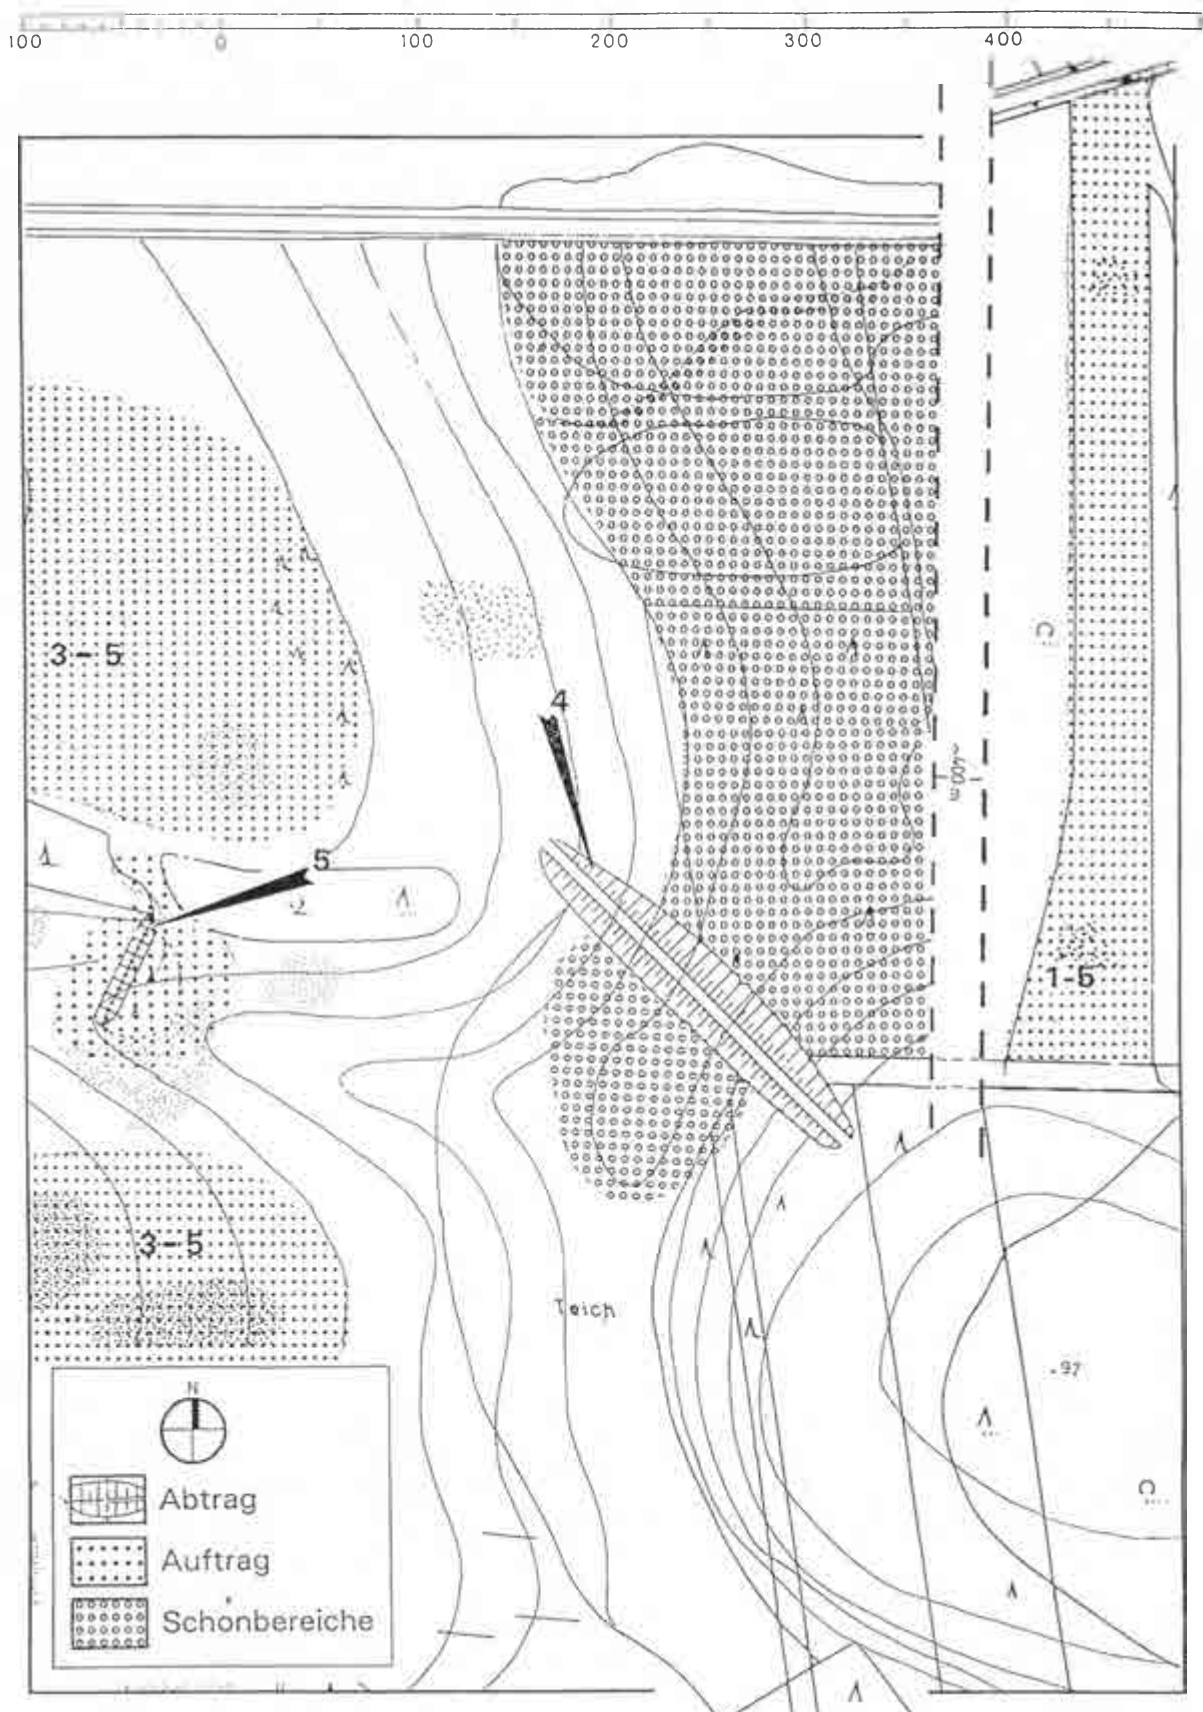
Detailplan 13.1 Möhregrund II. – Wallanlage mit kleinem überspannten Becken nahe Schneverdingen; Wallanlage mit überspanntem Becken 700 m westlich der B3.
